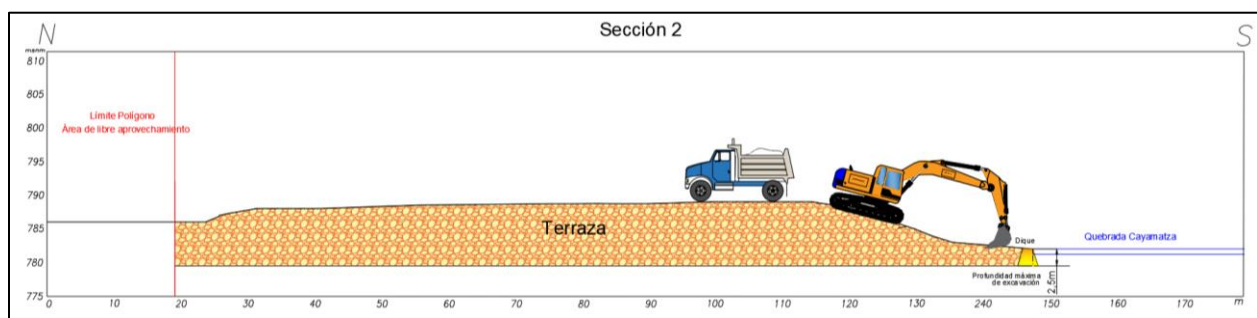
Vista en perfil de la fase de extracción en el bloque 1
